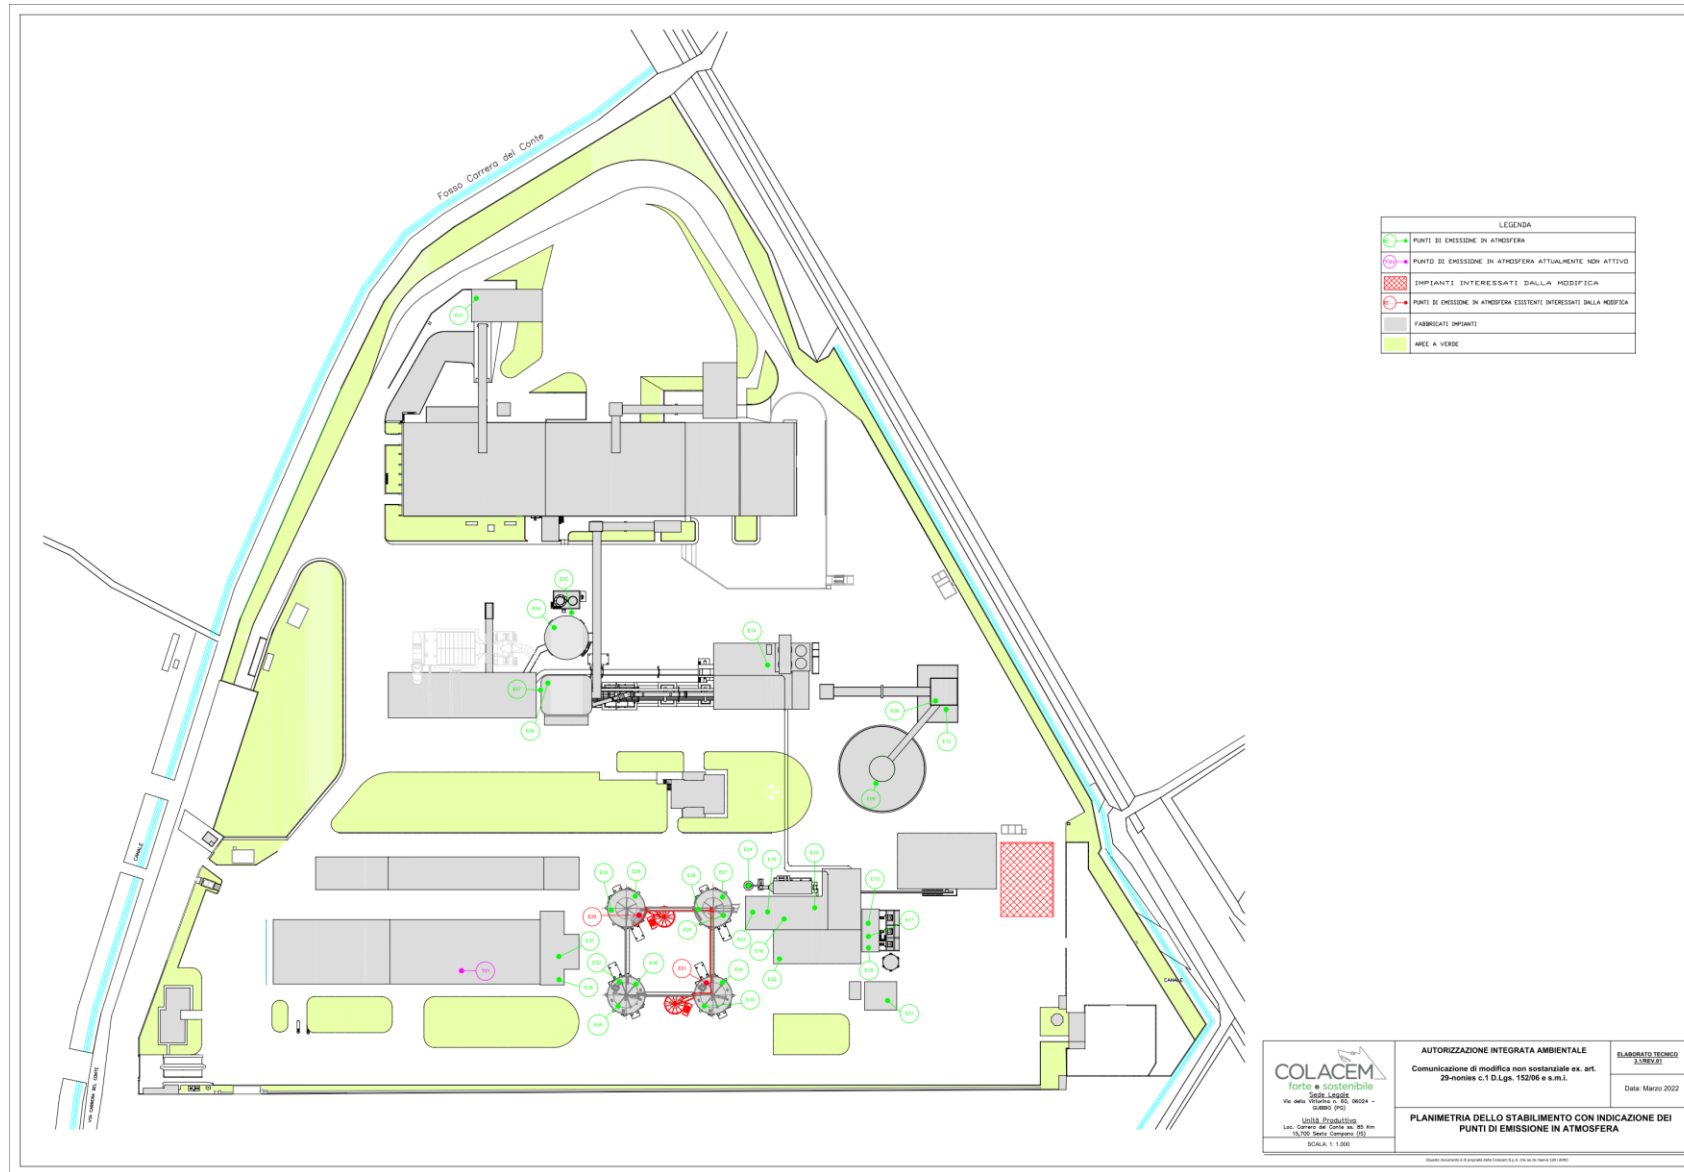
planimetria generale dell'installazione con indicazione dei punti di emissione in atmosfera: assetto "ante operam"
